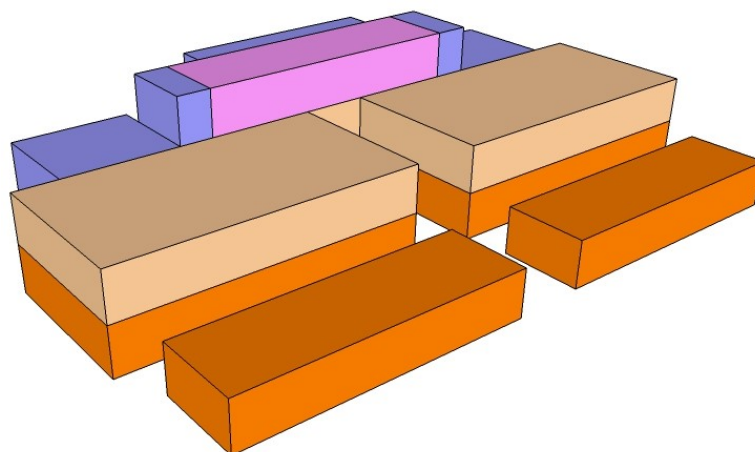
39 Konsep Tata Massa Bangunan Redesain Pasar Sentul Lantai 2
